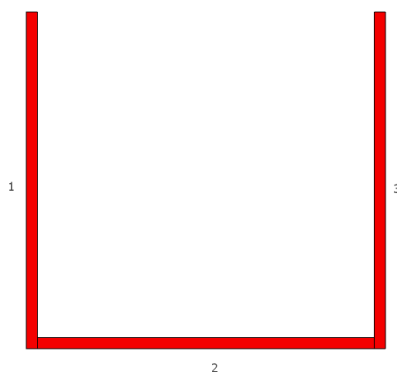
Figura esquemática – Planta pórticos de estabilização.
